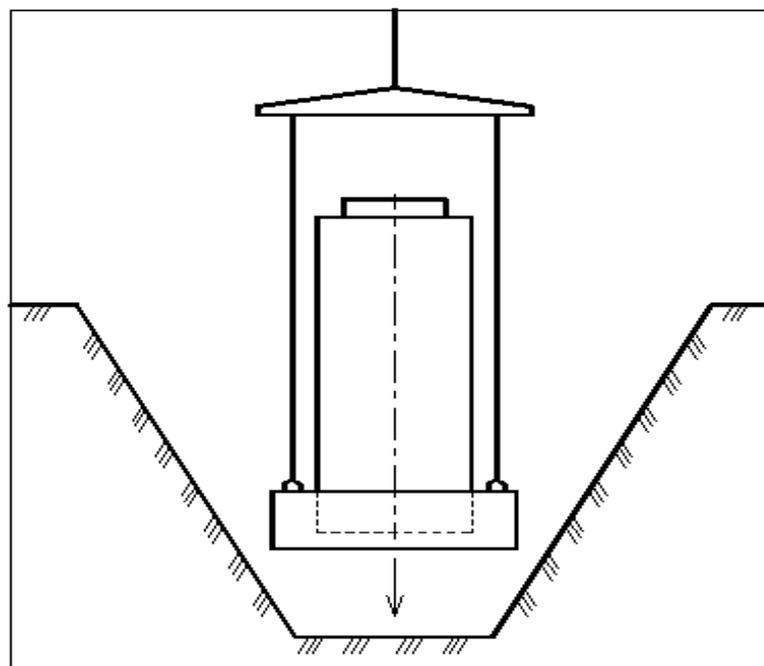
Схема монтажа колодца с бетонным основанием
